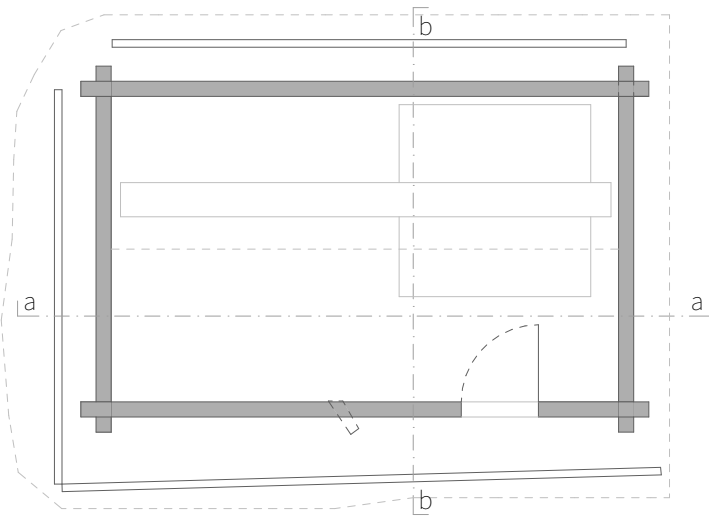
Grundriss Objekt 82a 1_100
